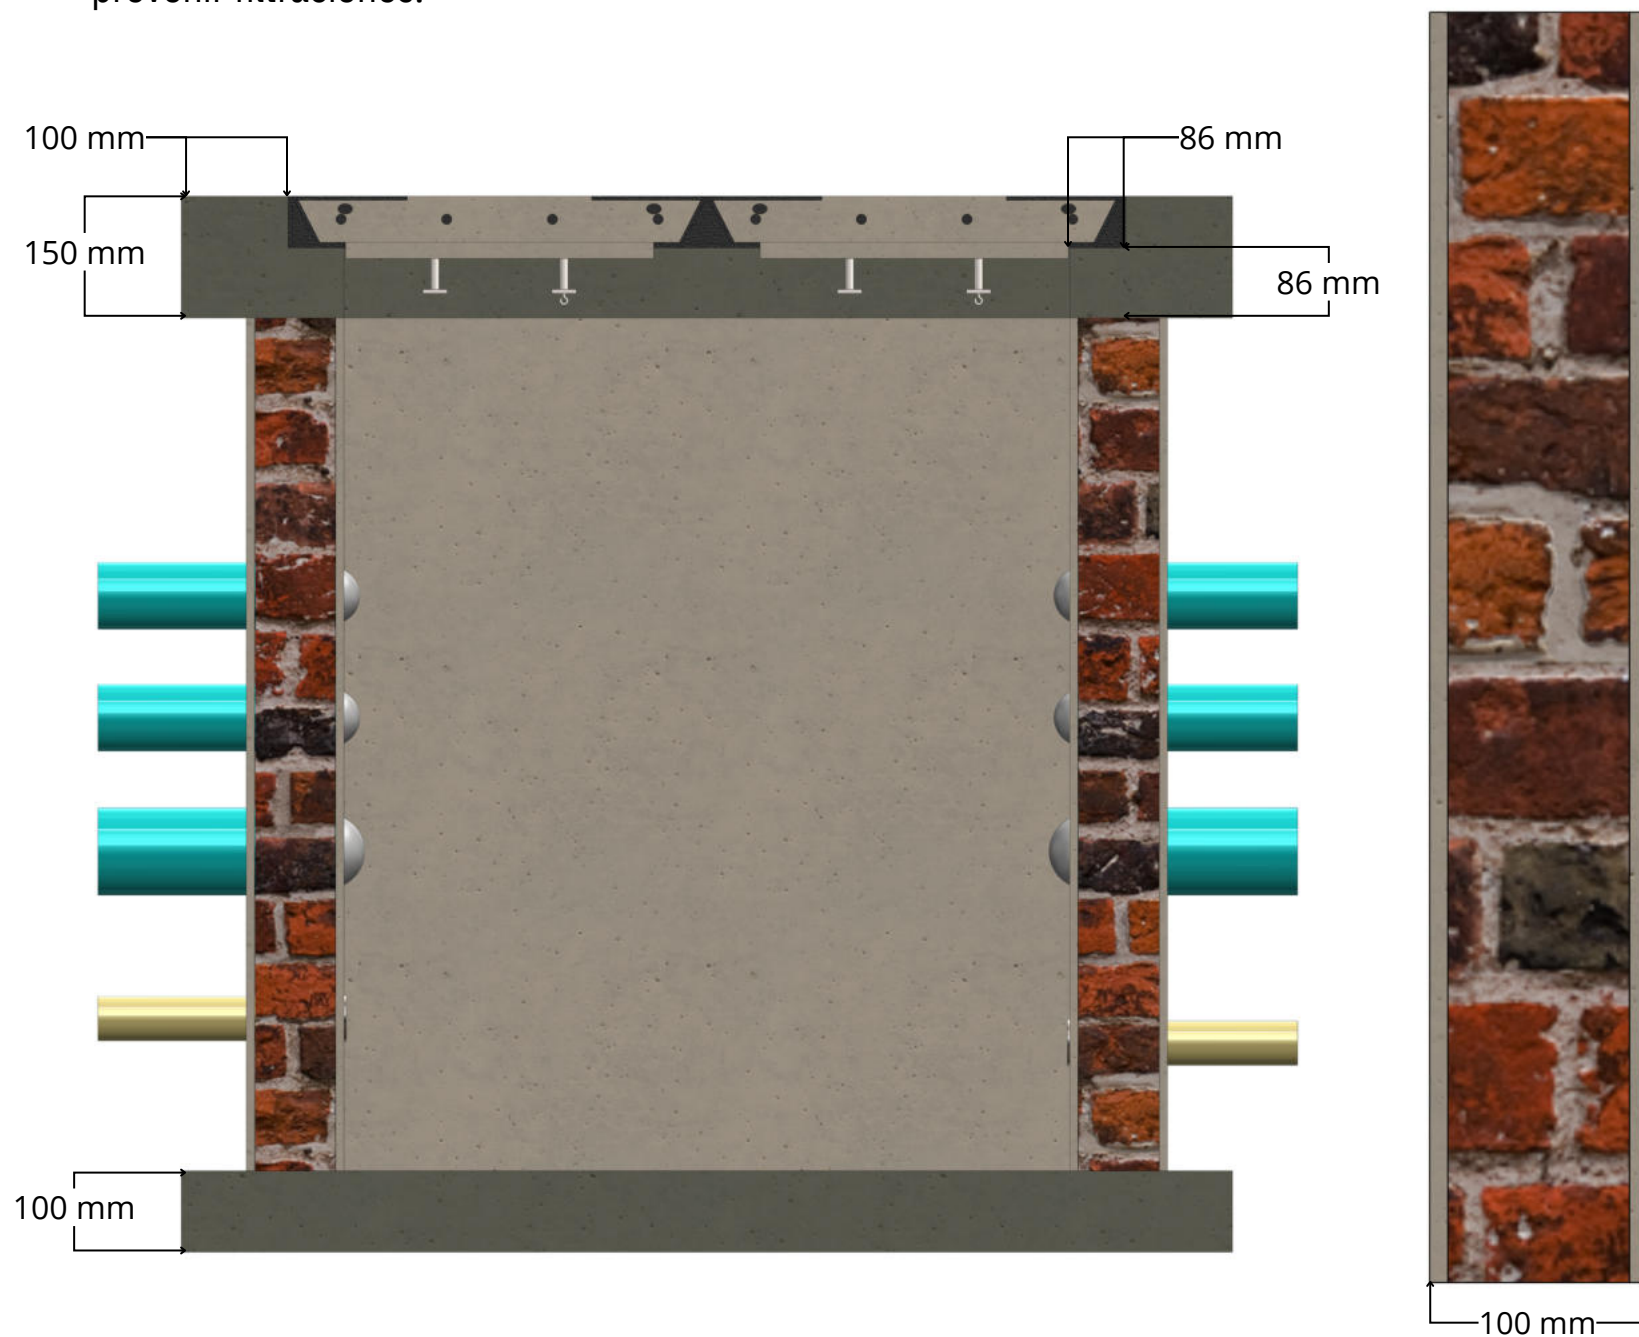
Detalle constructivo de pared de caja en ladrillo con recubrimiento impermeable
